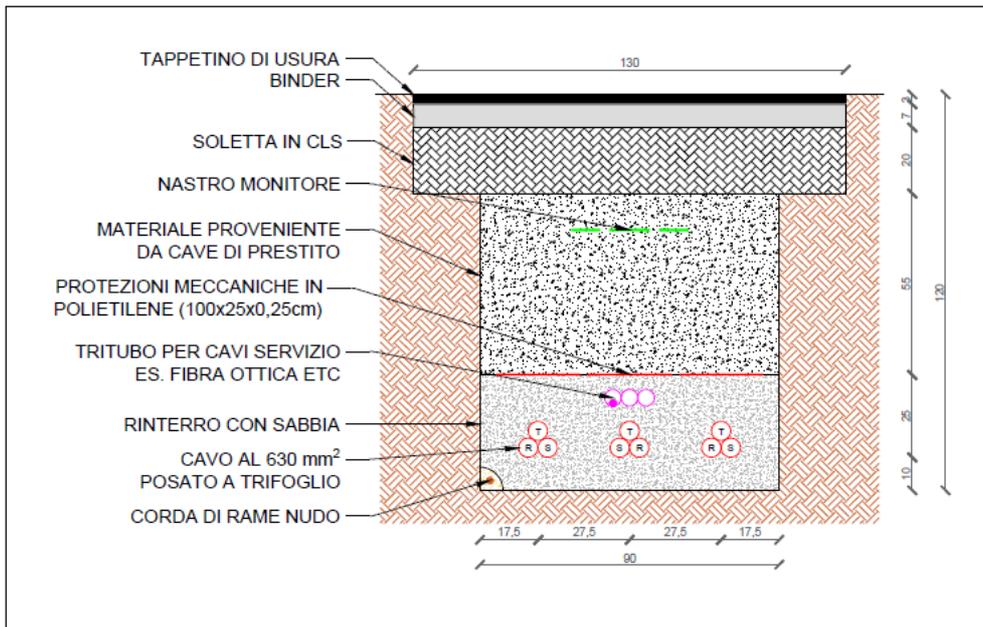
Sezione tipo di posa cavidotto M.T. su Strade Provinciali
